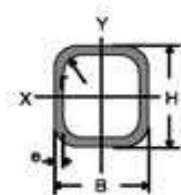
Corte transversal de un tubo estructural cuadrado
